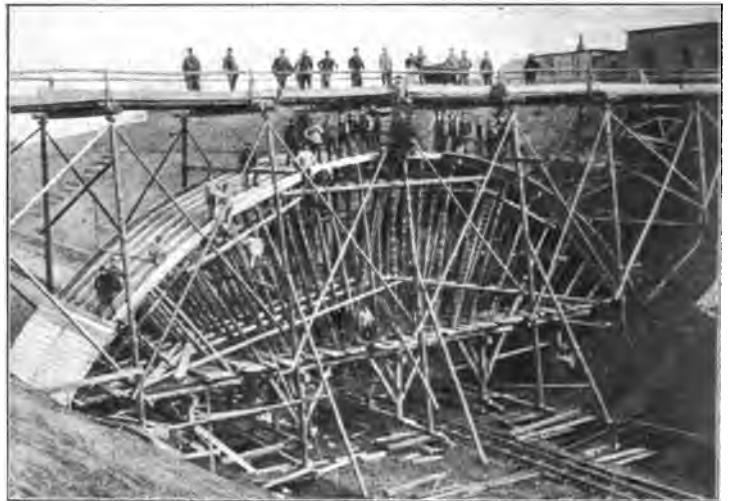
Lichtbild des Lehrgerüsts der Überführung der Holzstraße in Werdau.
